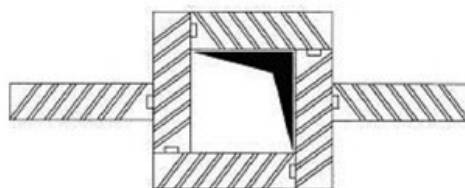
Pilier en blocs de plâtre sur toute la hauteur de la cloison
